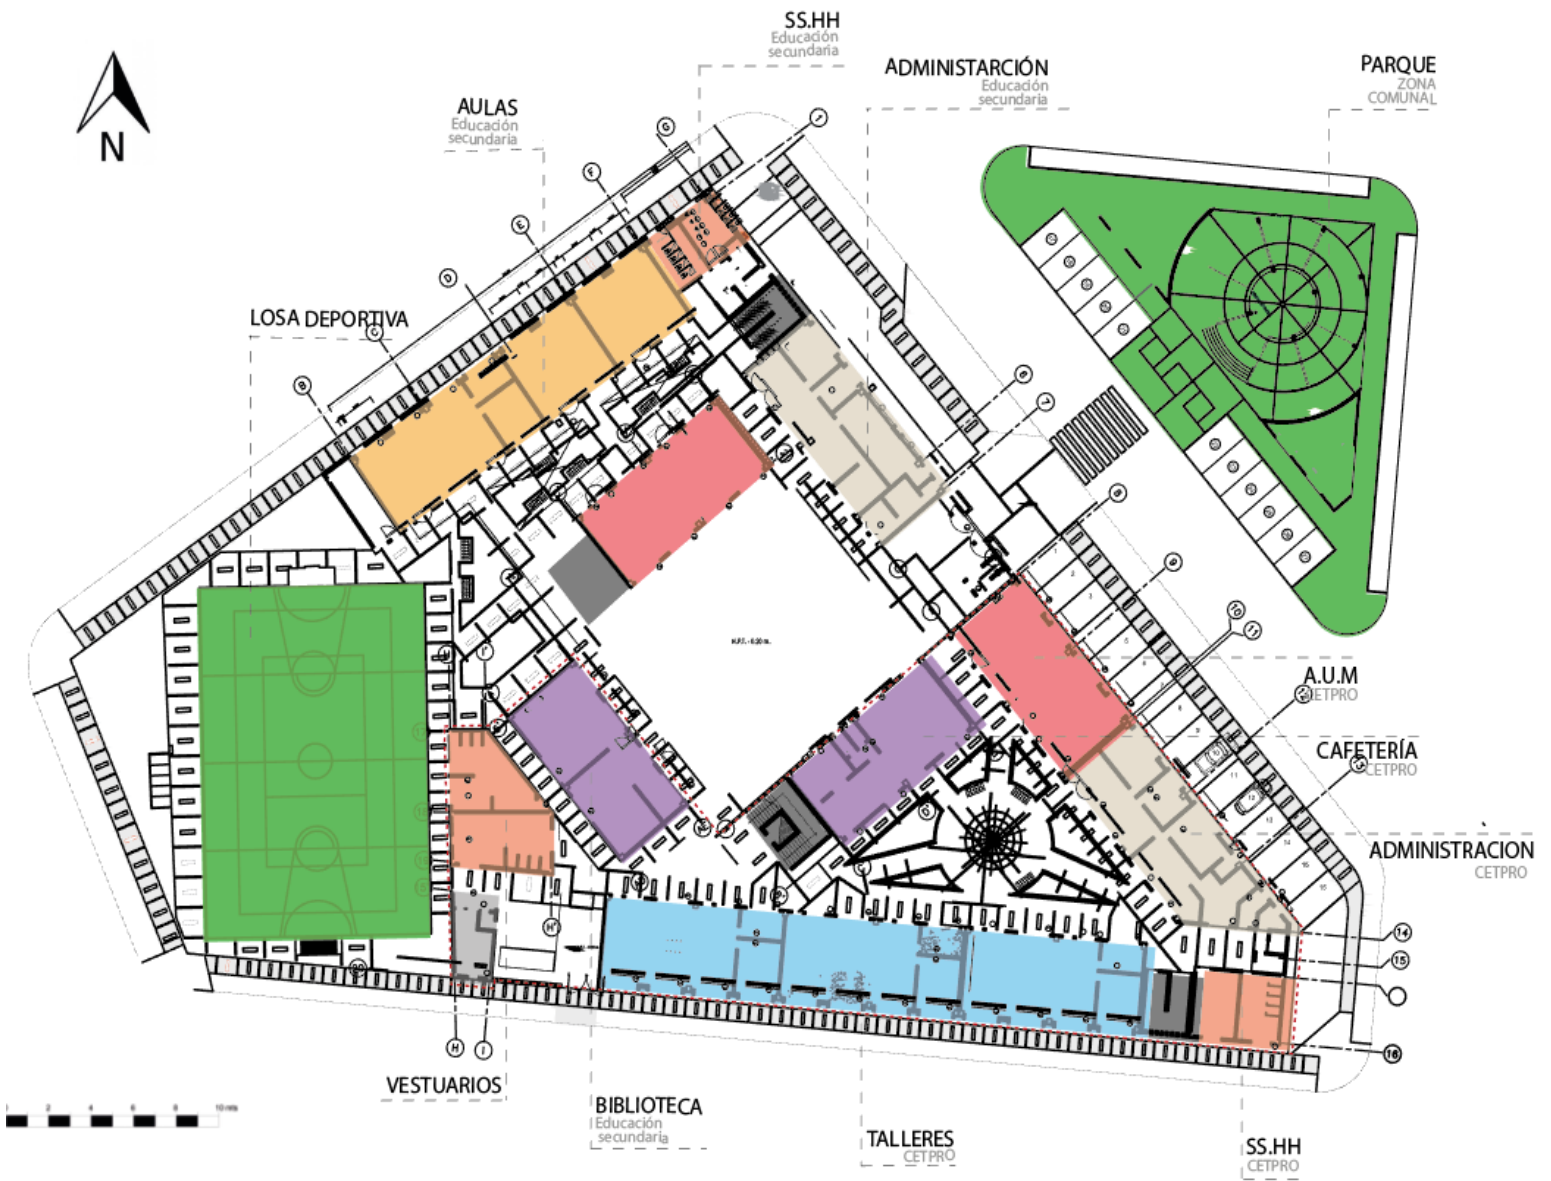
ESQUEMA PRIMERA PLANTA
